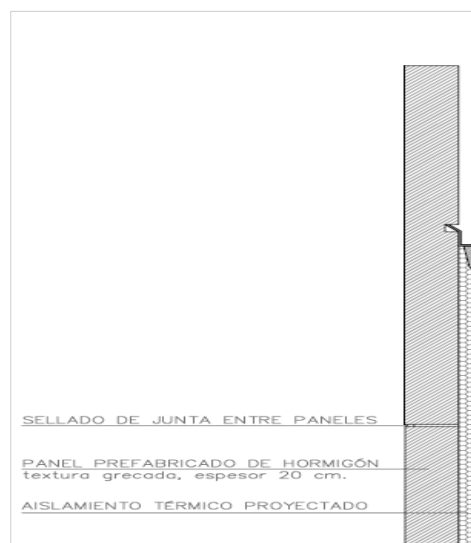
Materiales fachada panel prefab hormigón. Fuente: Proyecto de Ejecución.
